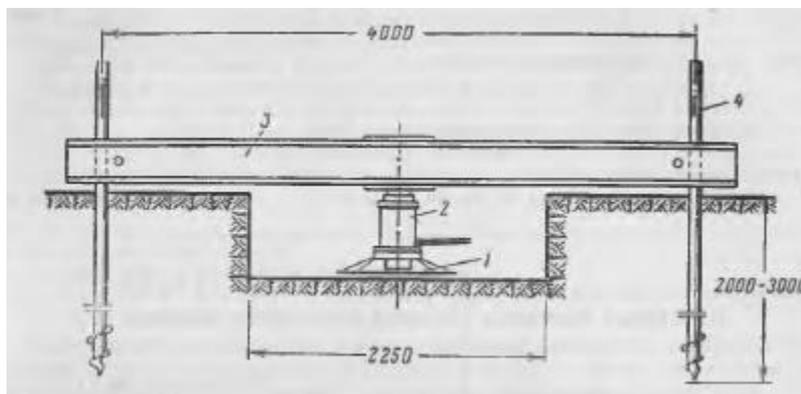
Схема установки для испытания грунтов статическими нагрузками штампом I типа: 1 - штамп; 2 - домкрат; 3 - упорная балка; 4 - анкерные сваи.
